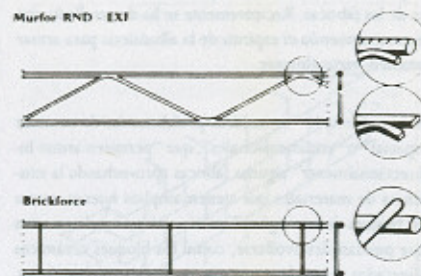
Armaduras prefabricadas planas para la fábrica armada
